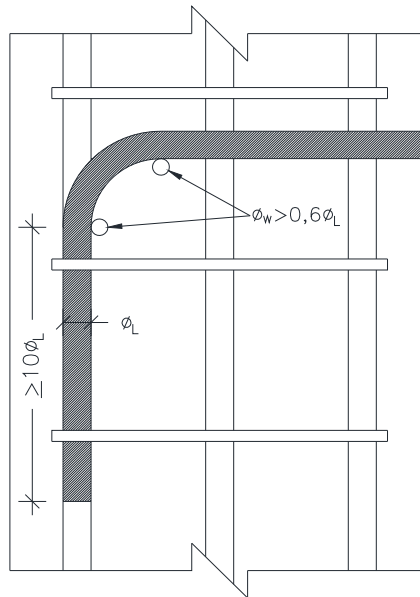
Disposições complementares para amarração nos nós viga-pilar exteriores
